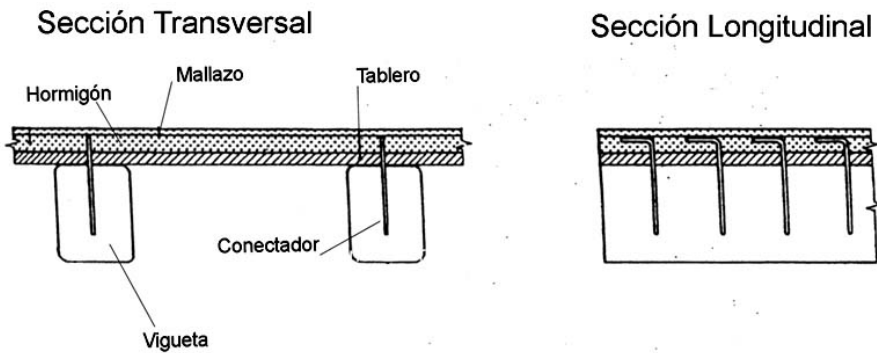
Conectores a cortante y flexión. La sección de hormigón no está en contacto directo con la viga de madera.
